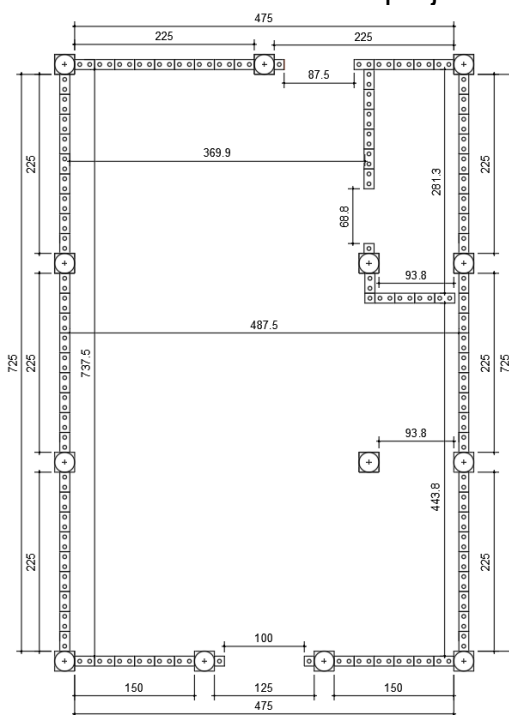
Trecho de uma planta genérica de 1ª fiada.
